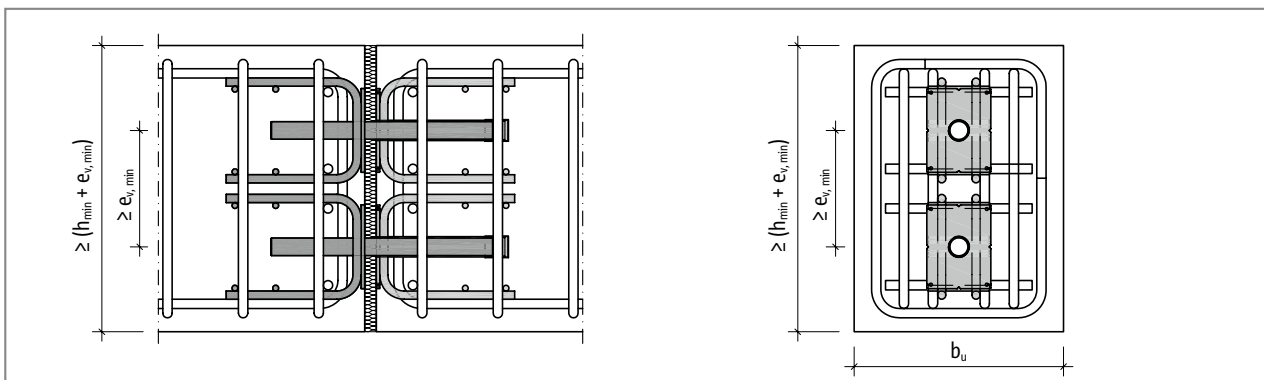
Schöck Dorn Typ SLD: Bauseitigen Bewehrung bei Balken Anschluss
